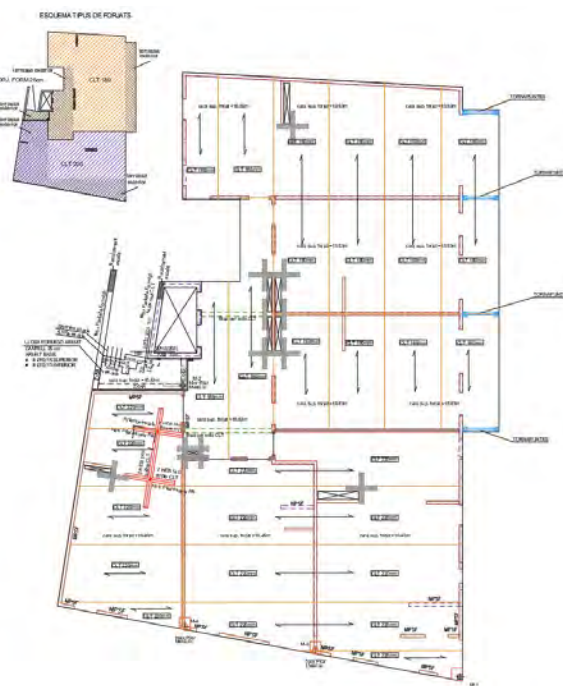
Representació en planta de la divisió dels panells, segons el projecte d'estructures.
